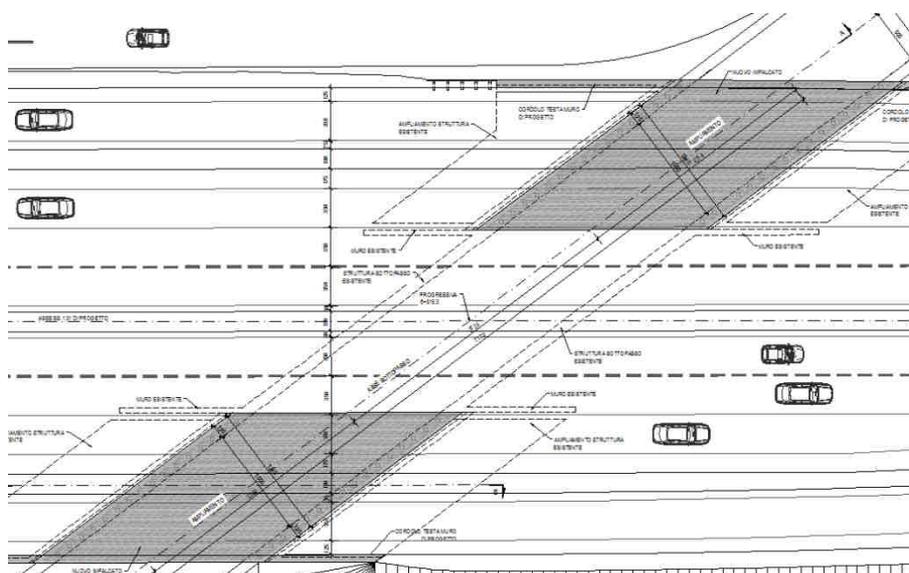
Planimetria – Sottovia ferroviario km. 6+825
